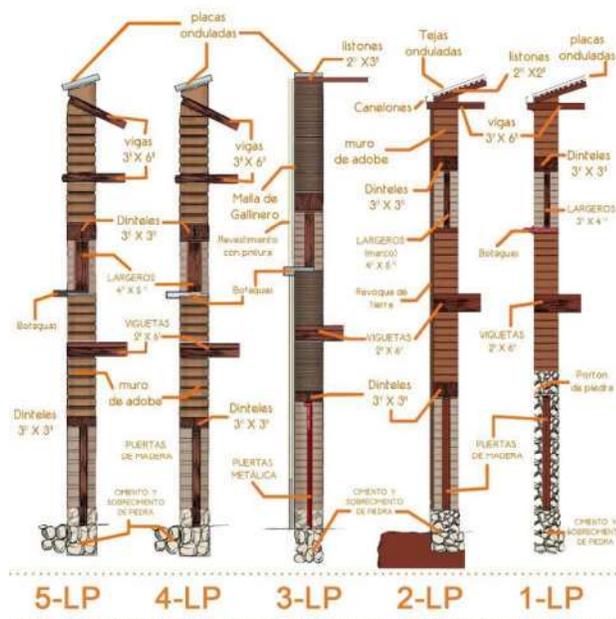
Detalles constructivos de los modelos de vivienda de la zona vivienda 1LP-5LP
